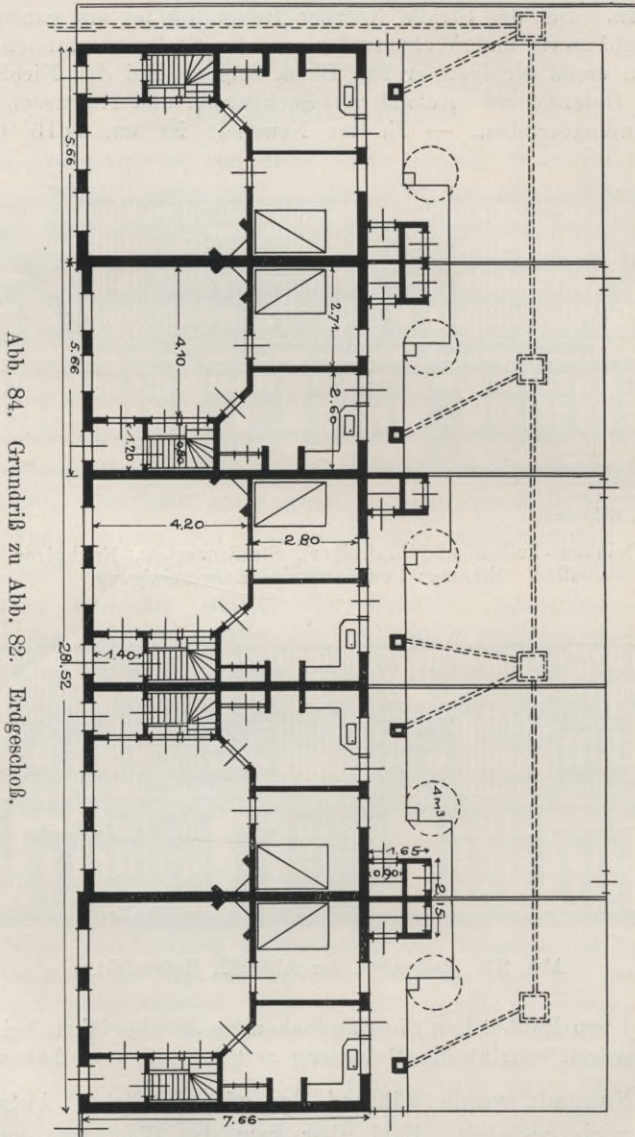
Grundriß zu Abb. 82. Erdgeschoss.
